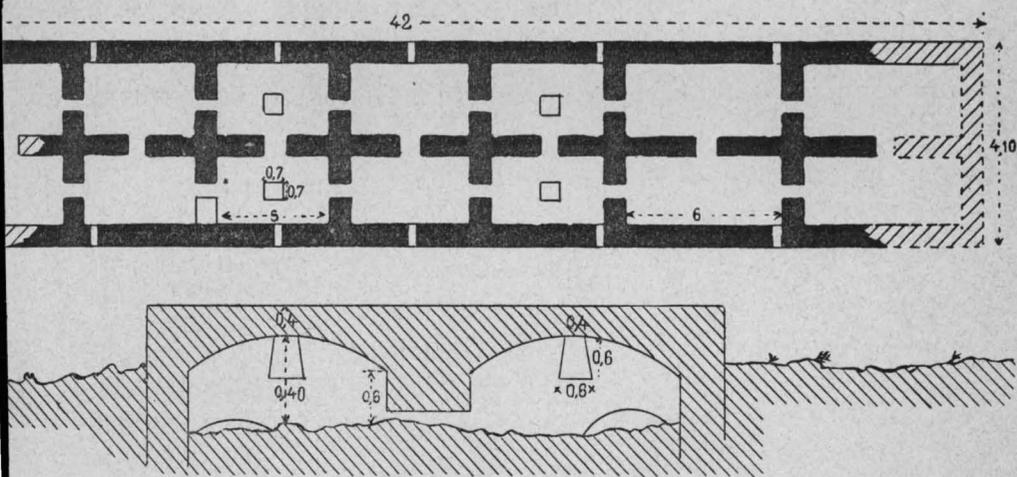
et 12. — PLAN ET COUPE DE LA FESGÜET-EL-GUETTAIA
